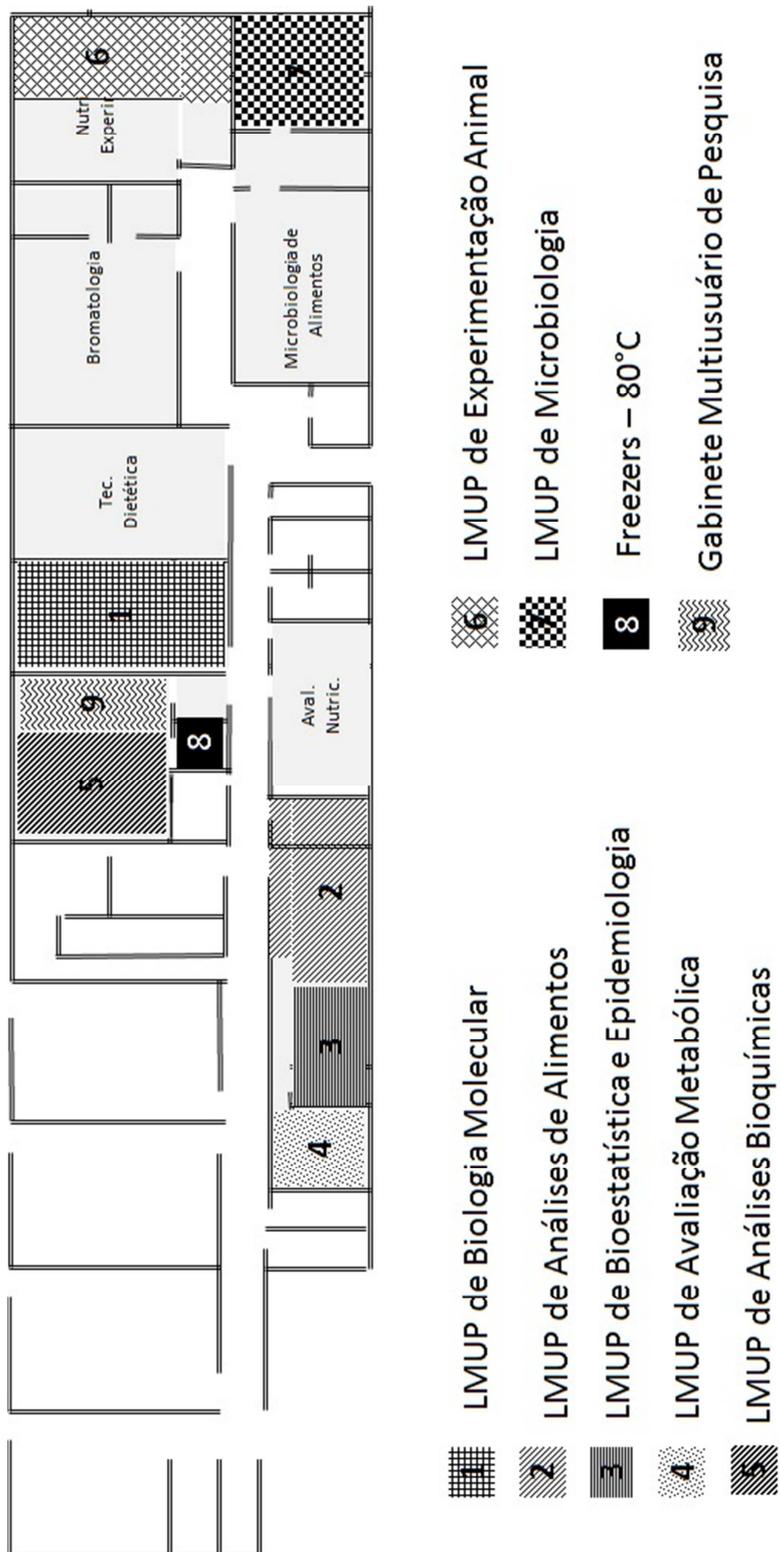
Planta baixa apresentando a localização dos LMUP da ENUT.
